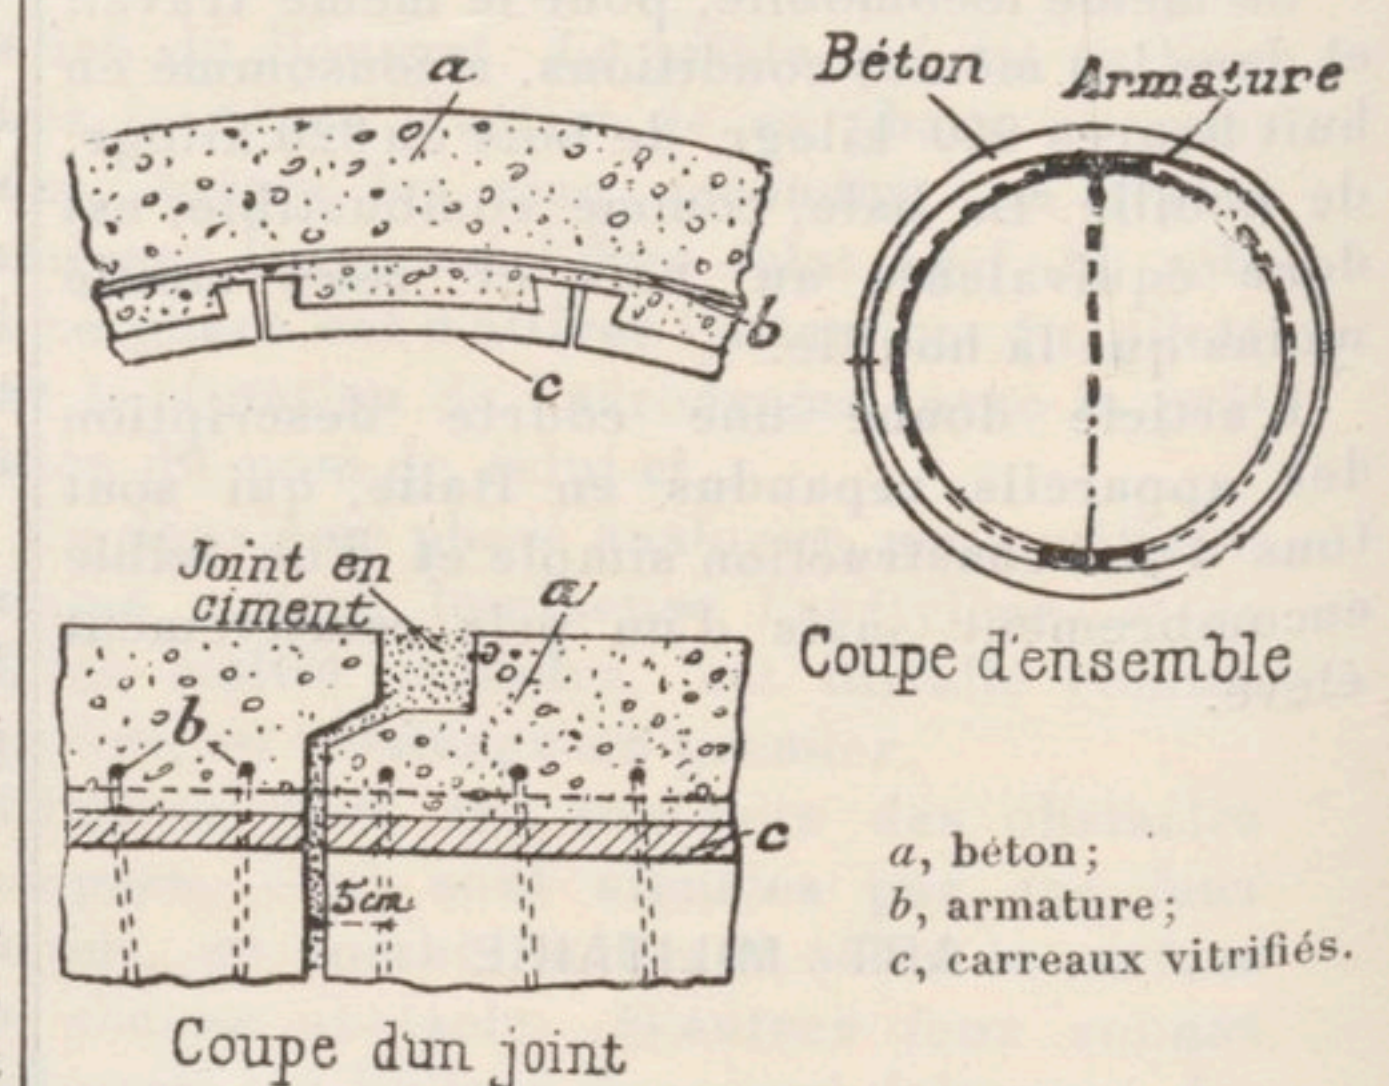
à 3. — Détails d'une conduite des nouveaux égouts de Los Angeles.
